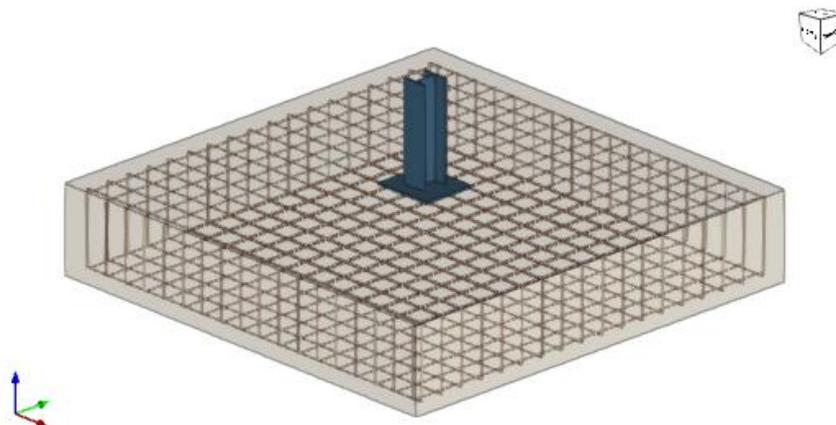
Vista general zapata esquina de pórticos hastiales
